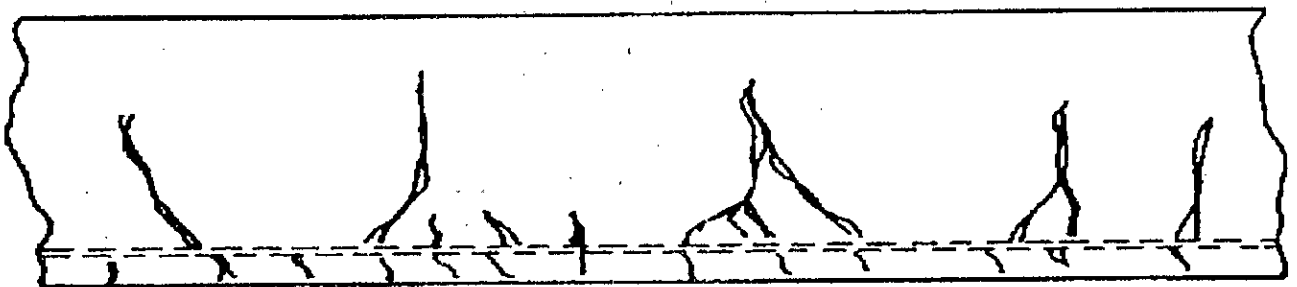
Exemple de tracé des fissures dans une poutre fléchie.
